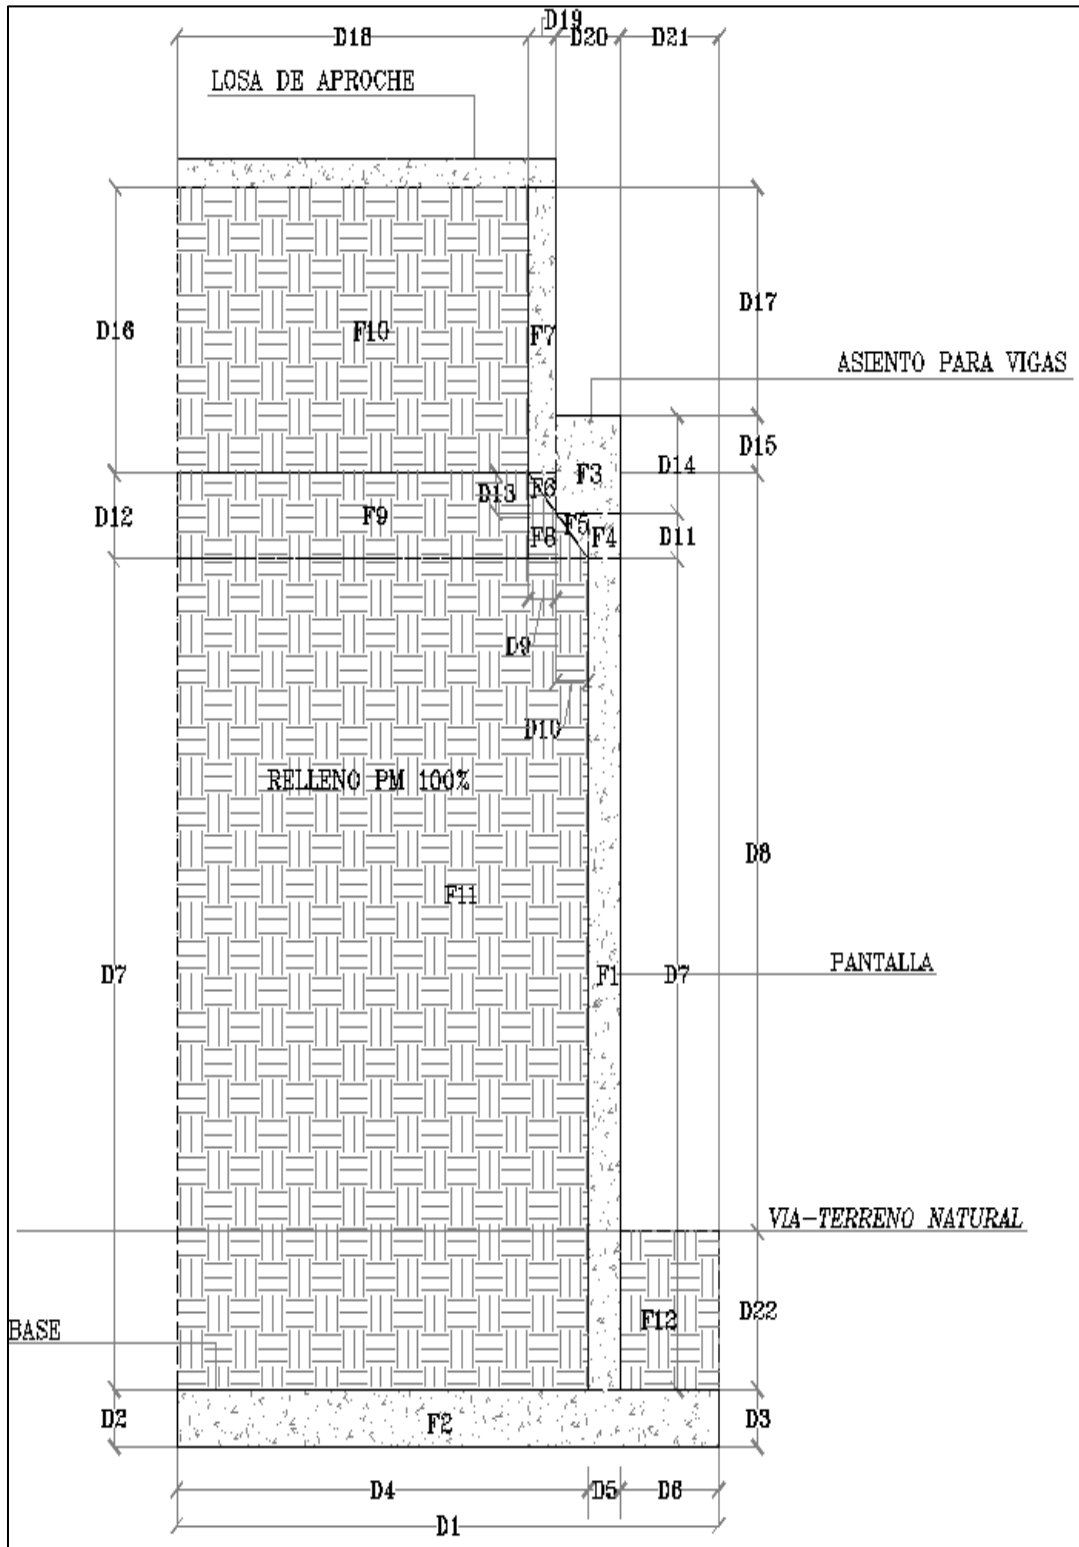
Esquemización sección transversal de estribo (elaboración propia).
